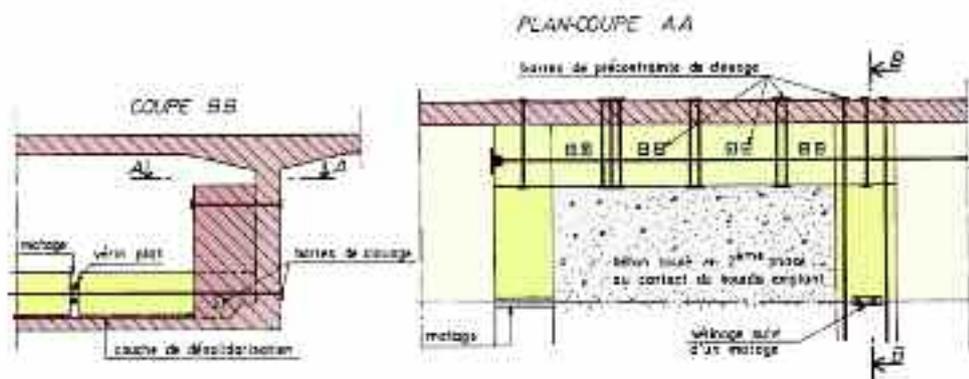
massif d'ancrage avec un tirant en béton précontraint et un buton en béton armé
